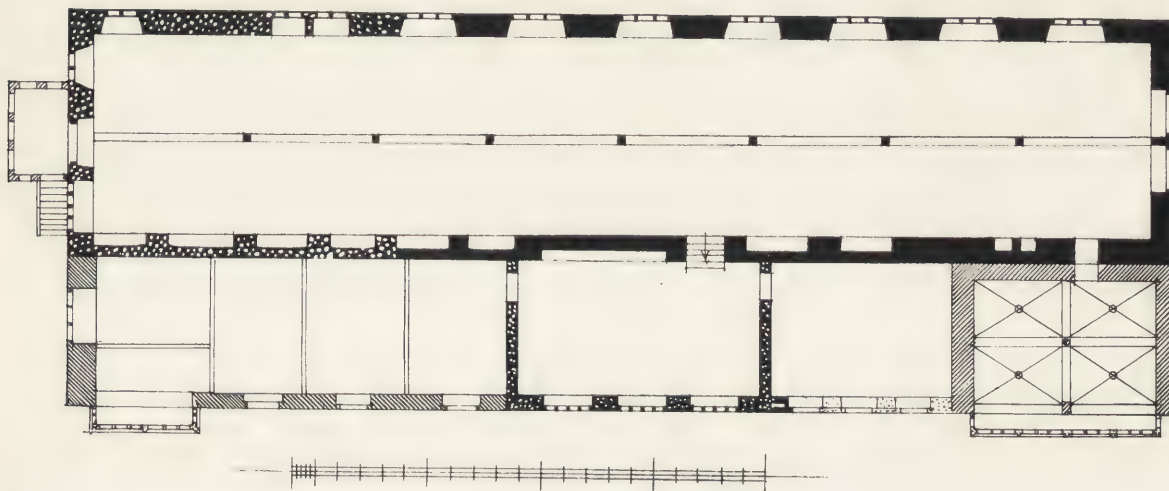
Rathhaus zu Lemgo. Grundriß des Hauptgeschosses.
